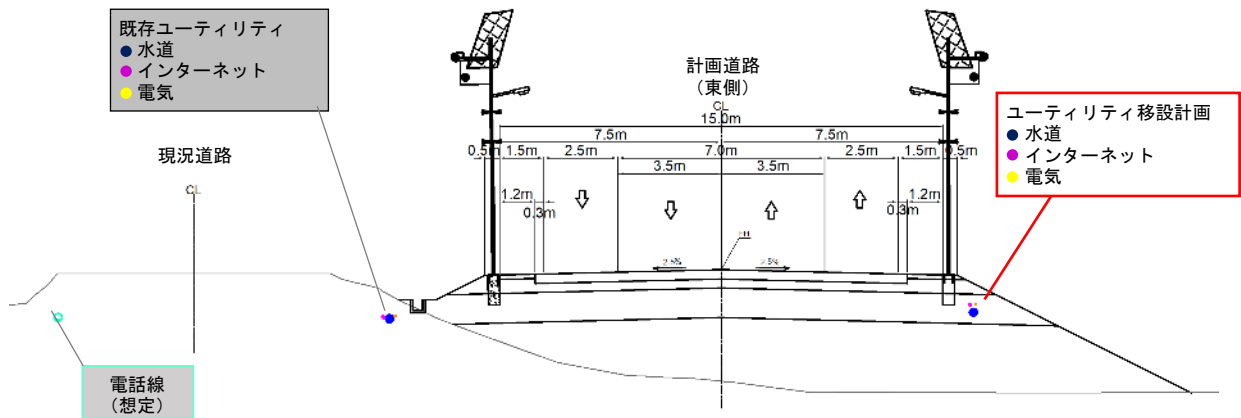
ユーティリティ配置、移設計画案 平面図
